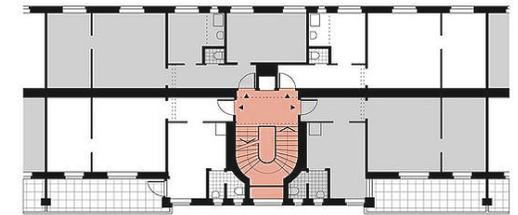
Planta tipo en el complejo Karl-Marx-Hof, 1926
